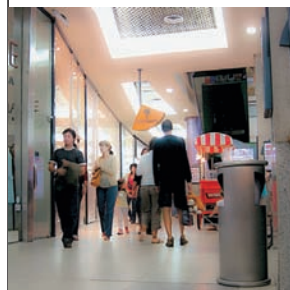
Detalle del sistema de ventilación en el Centro Comercial ParqueSur.
